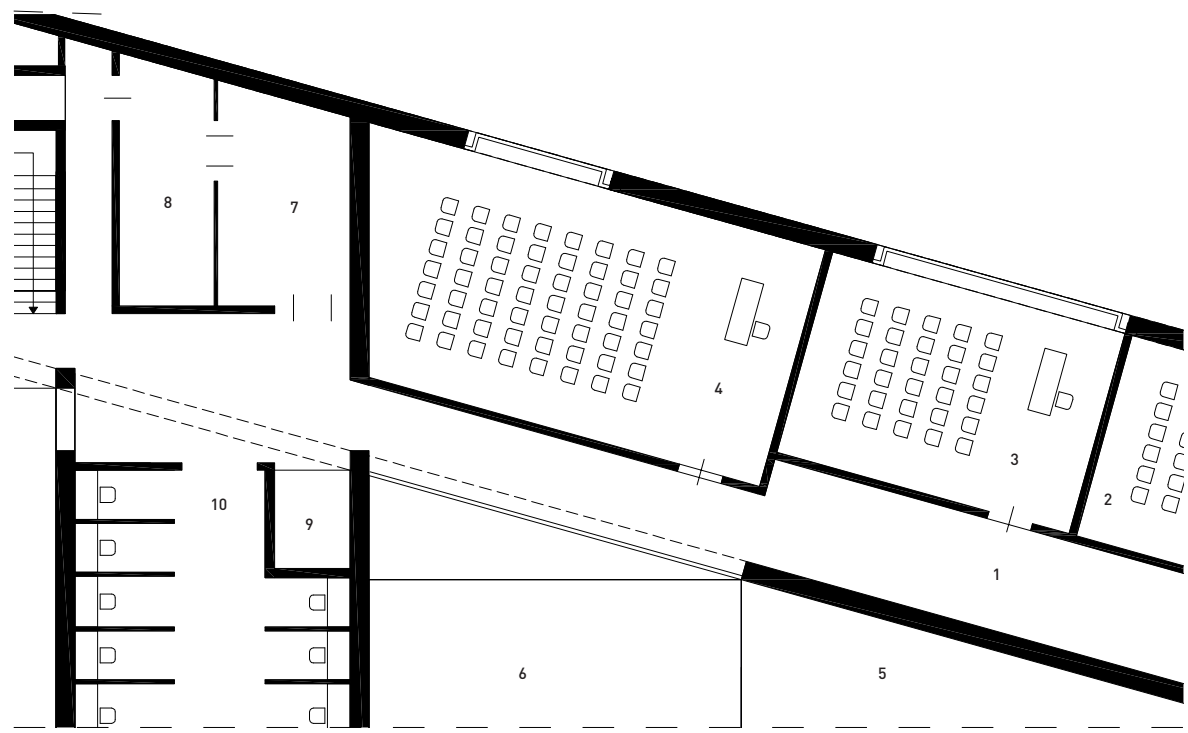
Grundriss Klassenzimmer\_3, Klassenzimmer\_4, Lagerbereiche M1:200
